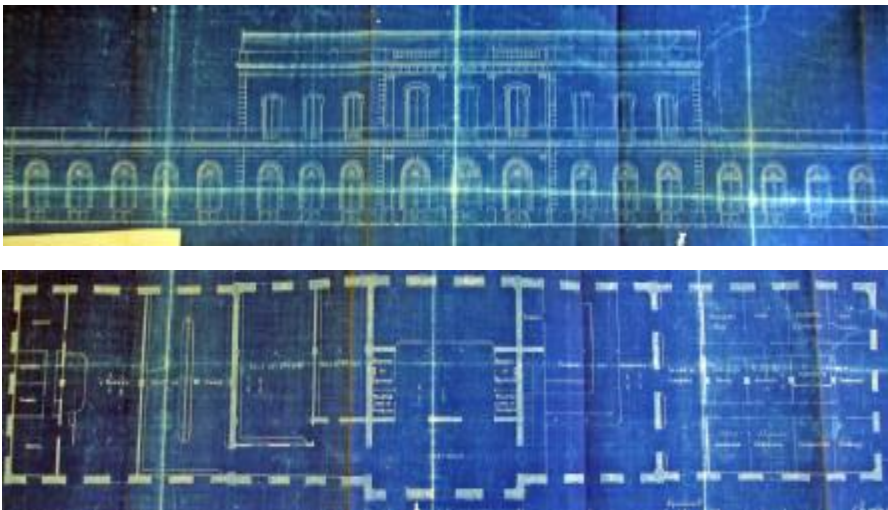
y 269.- Alzado principal y planta baja. E. Tarragona. (FFE). Archivo propio (2011).
